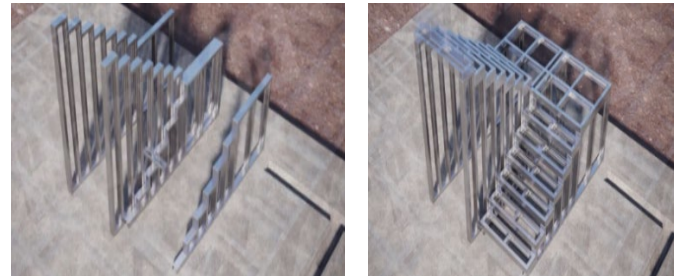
Döşeme kiriş kapaklarının montajı (Installation of floor beam covers) (Taşkiran, 2005)
